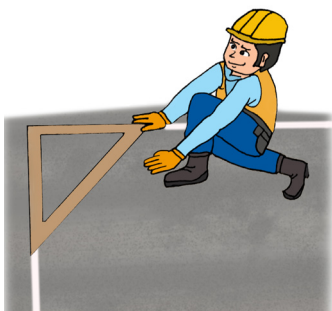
Replanteo de posición de muros sobre cadenas de cimentación y/o sobre losa para construcción de muros
